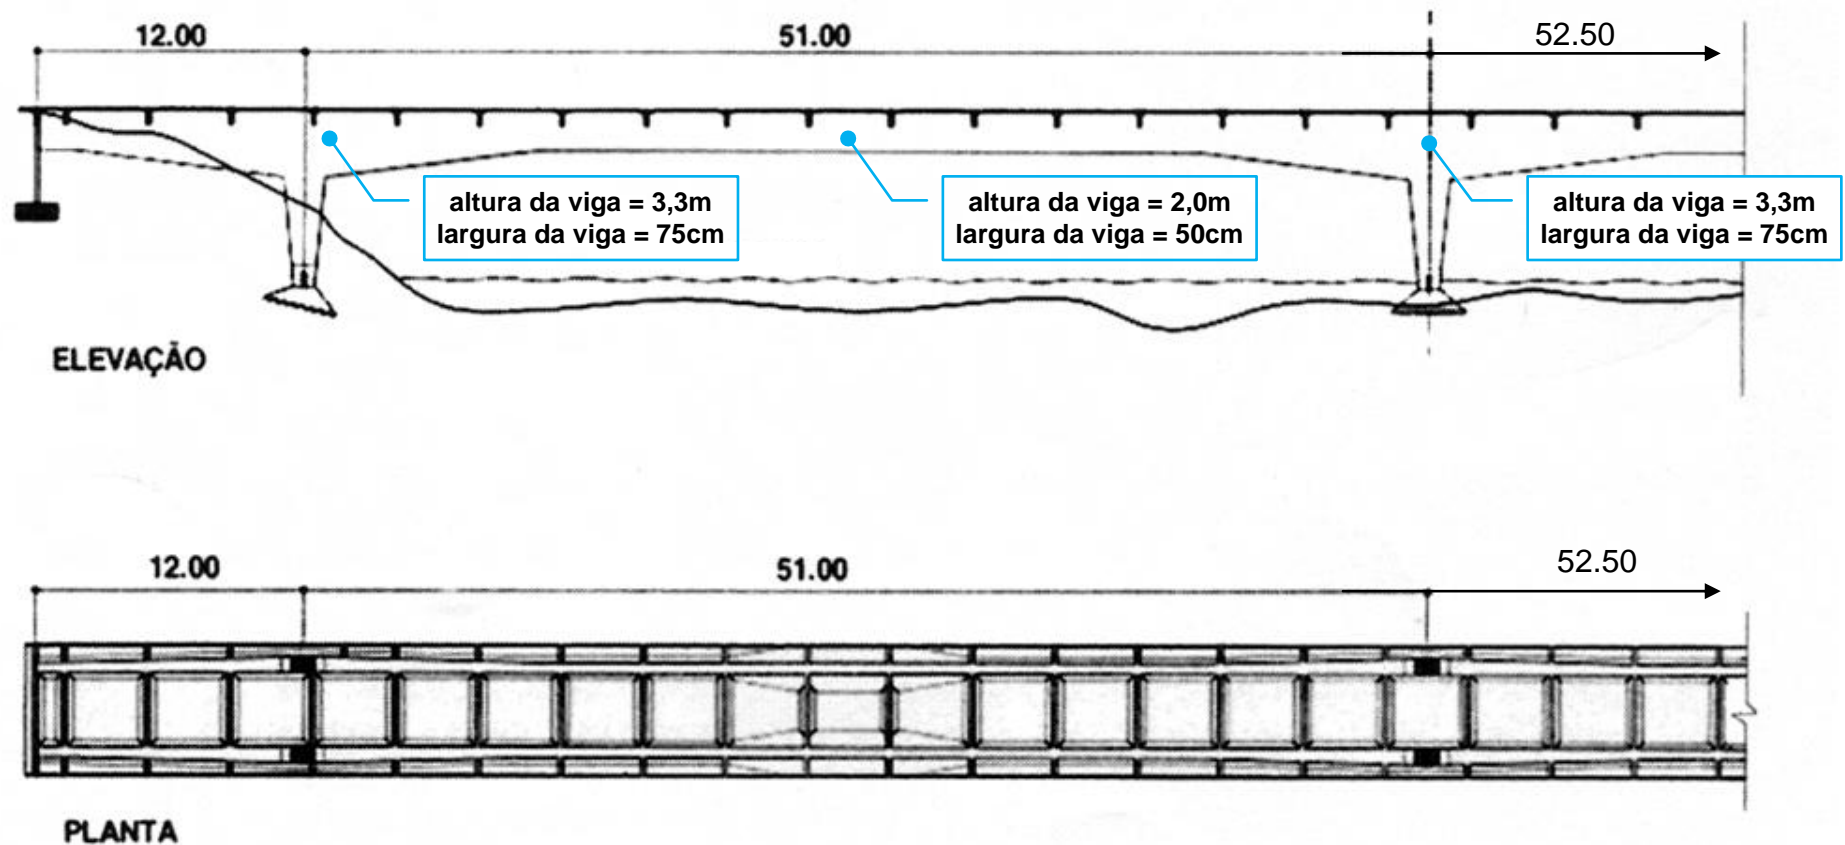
Elevação e planta da Ponte das Garças sobre o Rio Paraíba do Sul.
